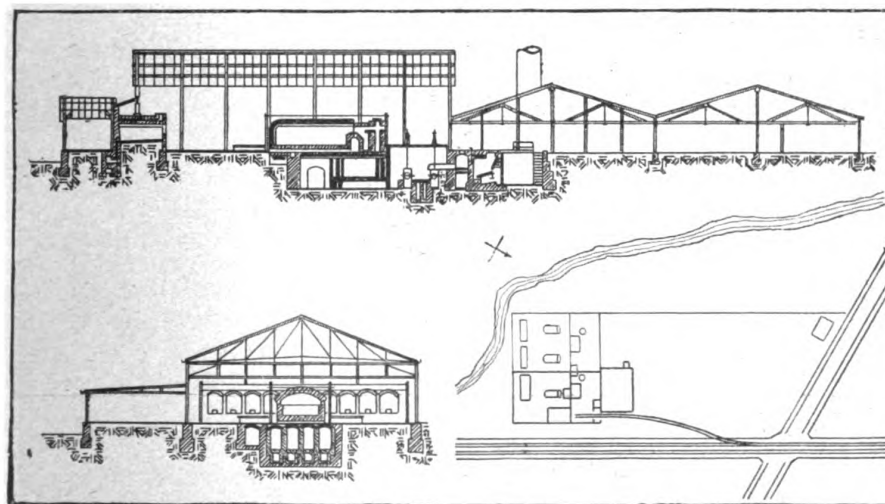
Längenschnitt, Querschnitt und Lageplan einer Glasfabrik.
